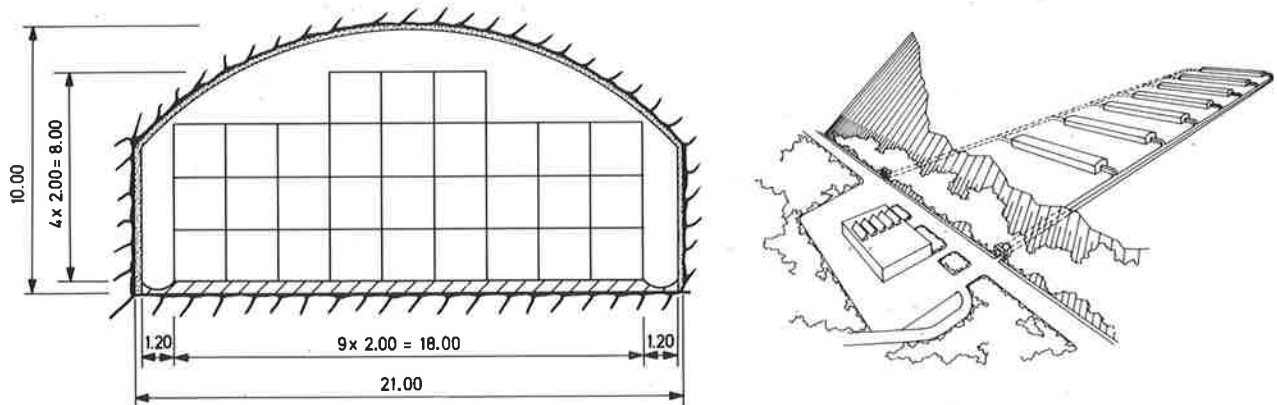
VARIANTE 3 / Coupe transversale et ensemble
